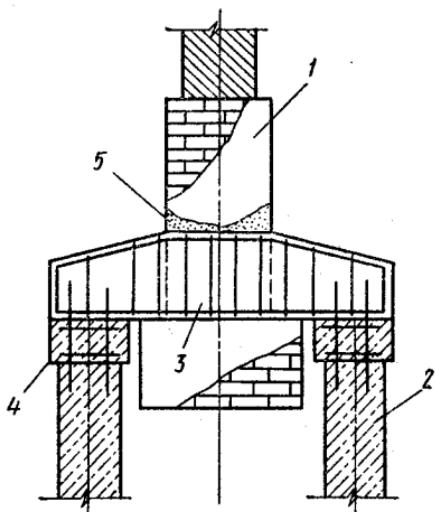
Усиление ленточного фундамента на естественном основании сваями с устройством рамной системы:
